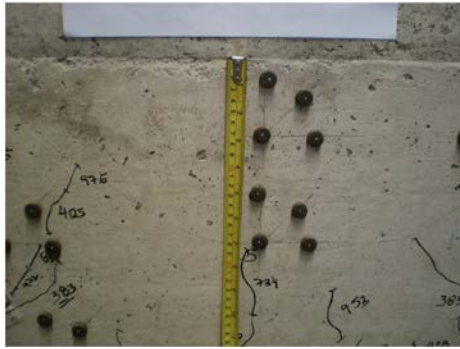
Configuração final de fissuras modelo B127P500R25
